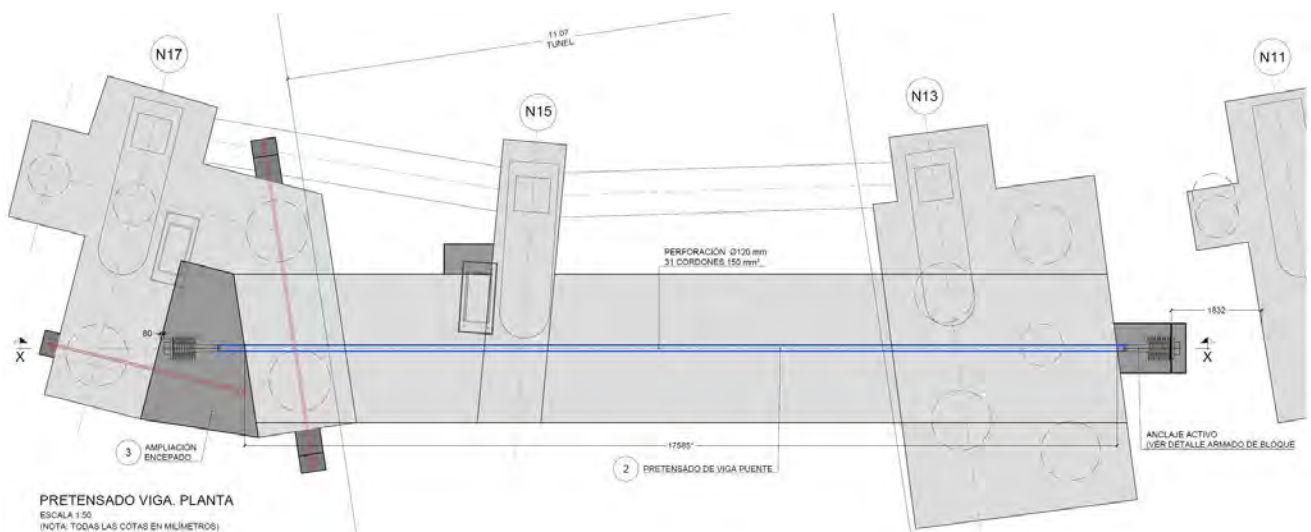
Planta de una de las estructuras sobre el túnel que muestra las sucesivas intervenciones de 1947, 1994 y refuerzo actual. El apoyo de los nuevos soportes de cubierta están junto a las costillas N15 y N17.
